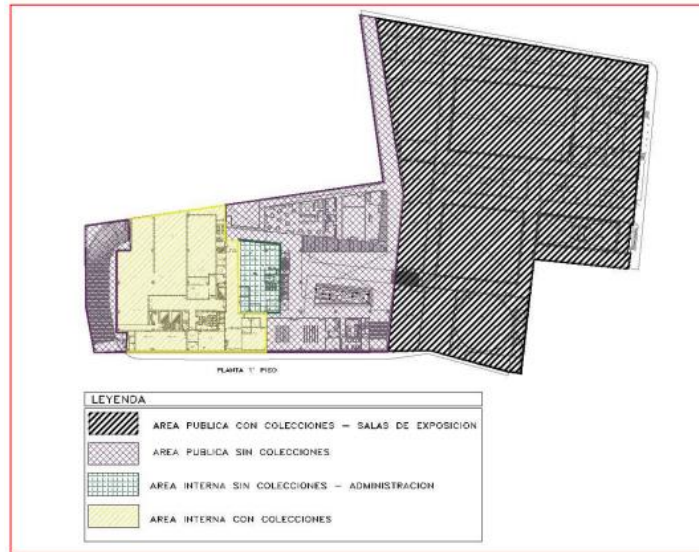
Planta 1er Piso. Fuente: Equipo consultor.
